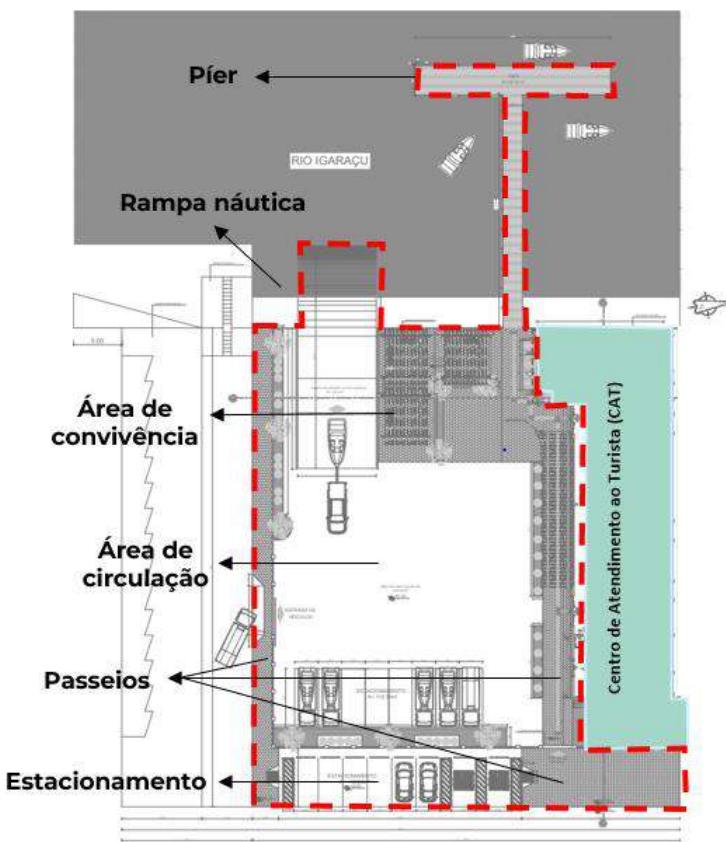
Layout preliminar das infraestruturas náuticas propostas para Parnaíba
